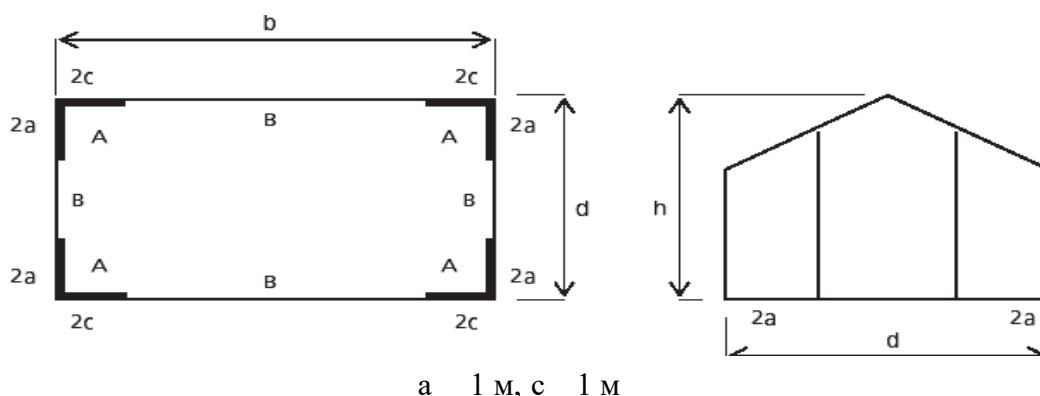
Зоны нагрузки ветра на наружные стены здания
